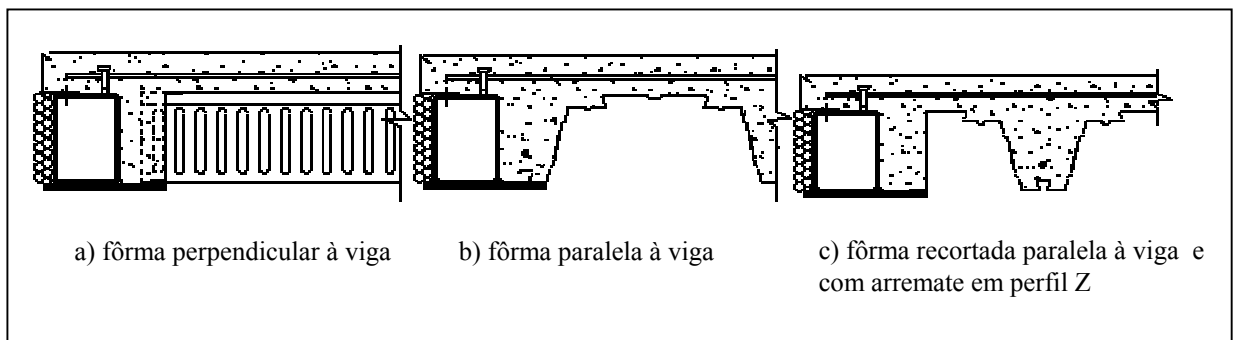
Viga mista de borda em perfil retangular (Fonte catálogo da CORUS)
